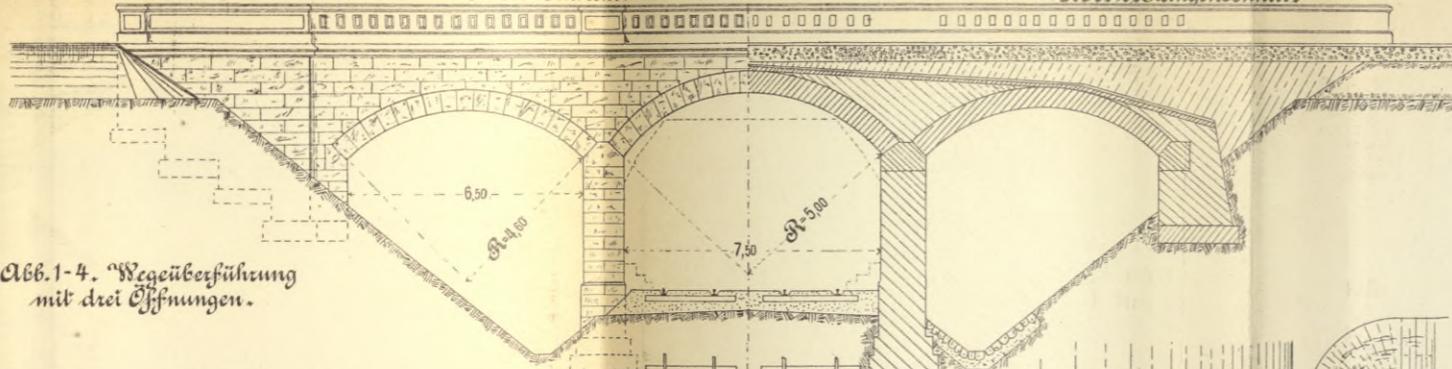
Wegeüberführung mit drei Öffnungen.
